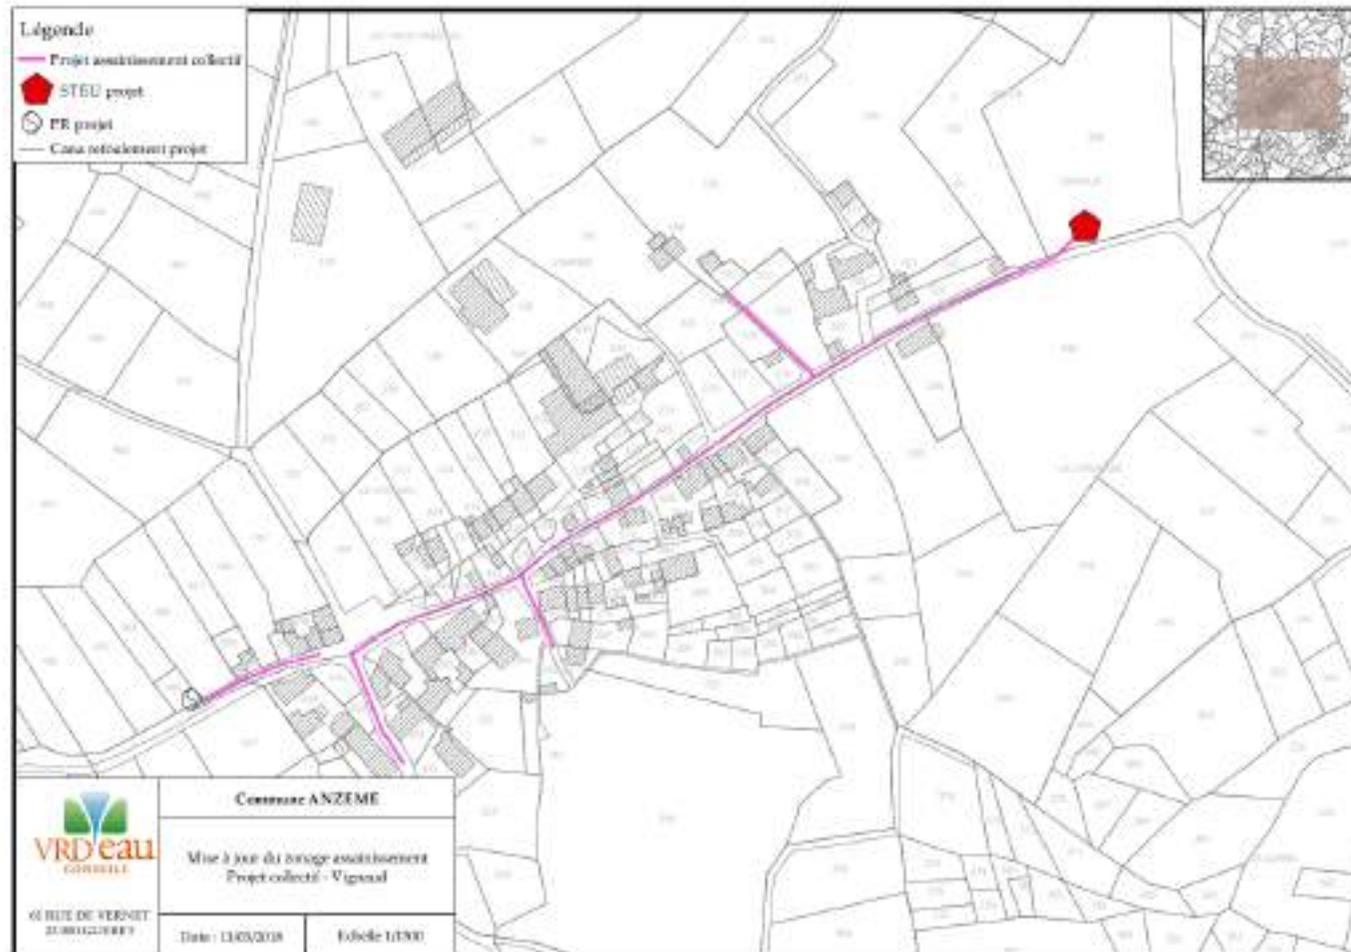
projet d'assainissement collectif sur le village du Vignaud
